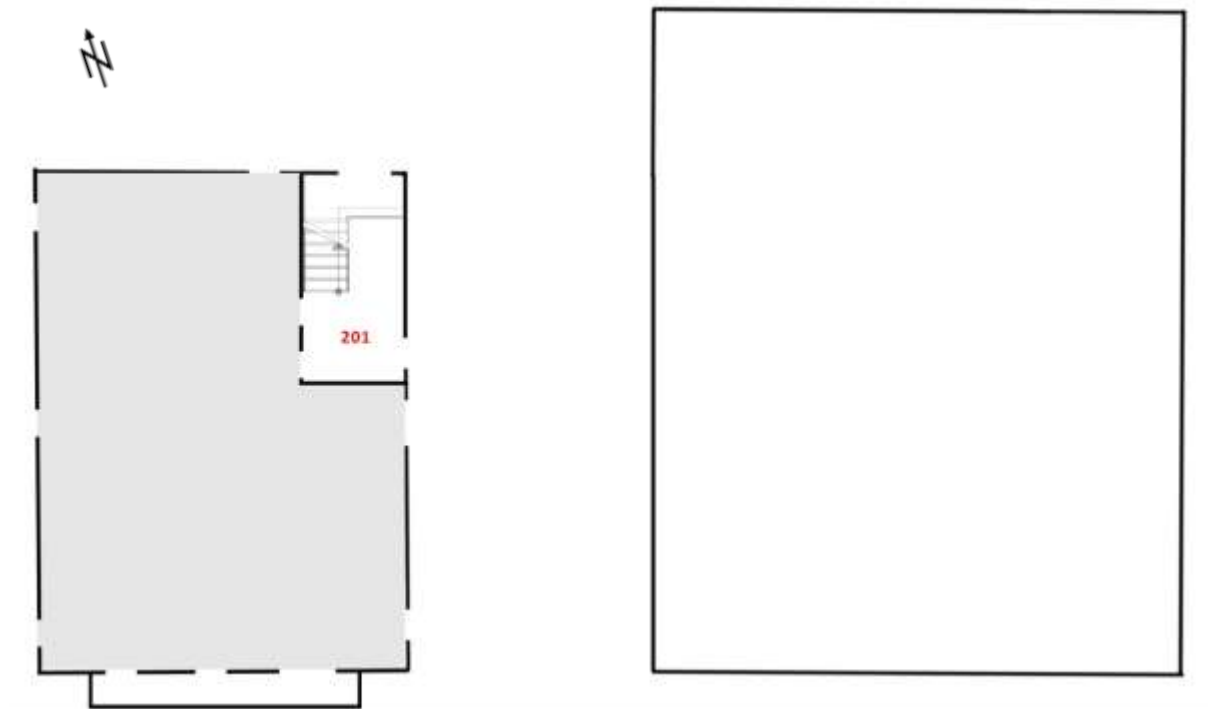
Schematischer Grundriss 2. Obergeschoss. Bearbeitung IBID.
